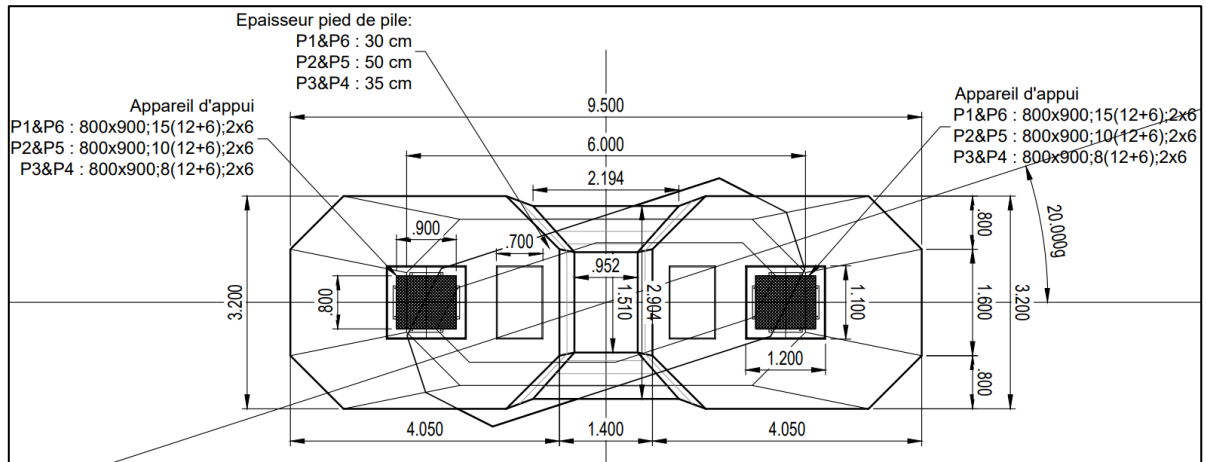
schémas des vues en plan des piles et chevêtres (source plans guide)
